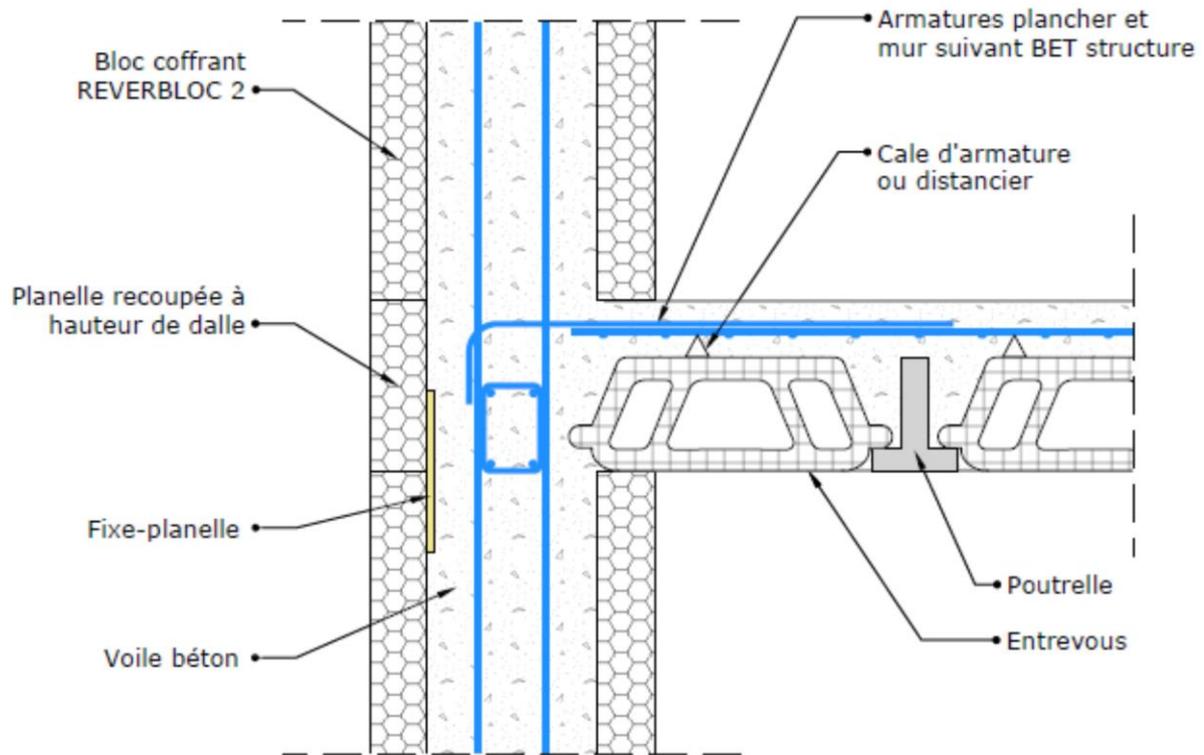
liaison mur/plancher à poutrelles (coupe dans le sens longitudinal)
